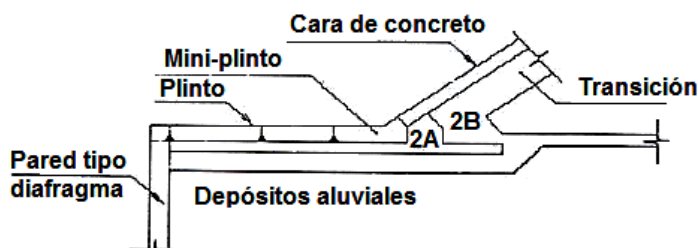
PLINTO ARTICULADO (SANTA JUANA – PUCLARO)
